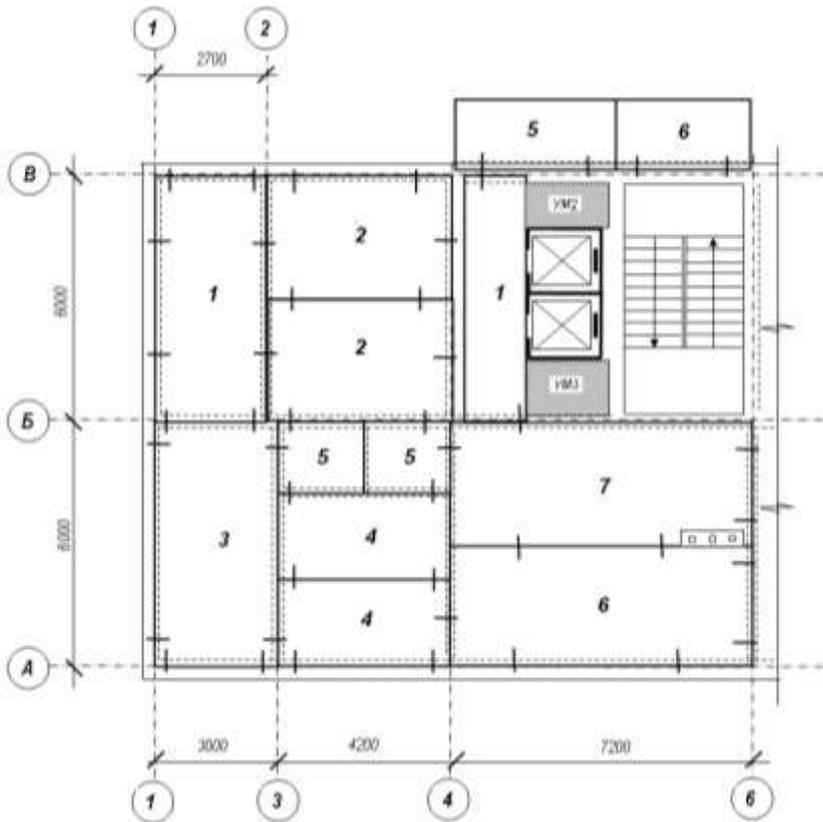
Пример оформления схемы расположения элементов перекрытия (из сплошных железобетонных панелей) жилого дома
